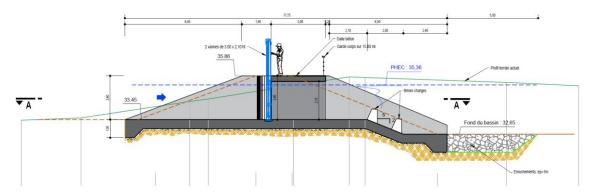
Ouvrage de remplissage du bassin de compensation de SANOFI
